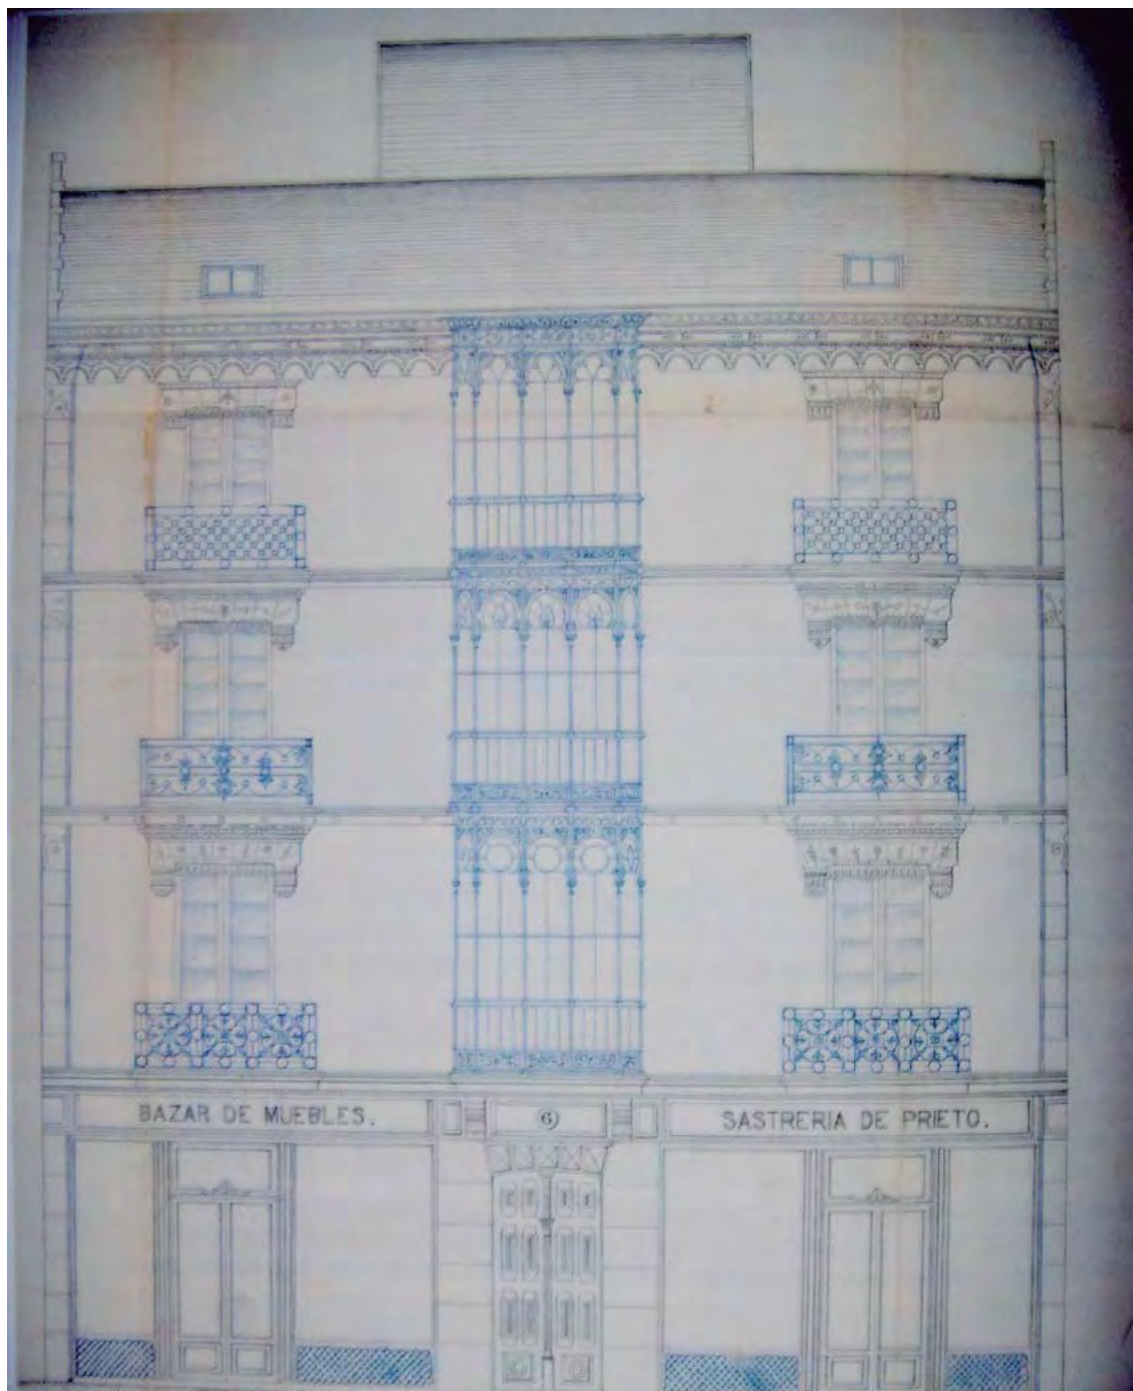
Plano de fachada de la Casa Prieto (1884). Arquitecto Segundo Viloria
